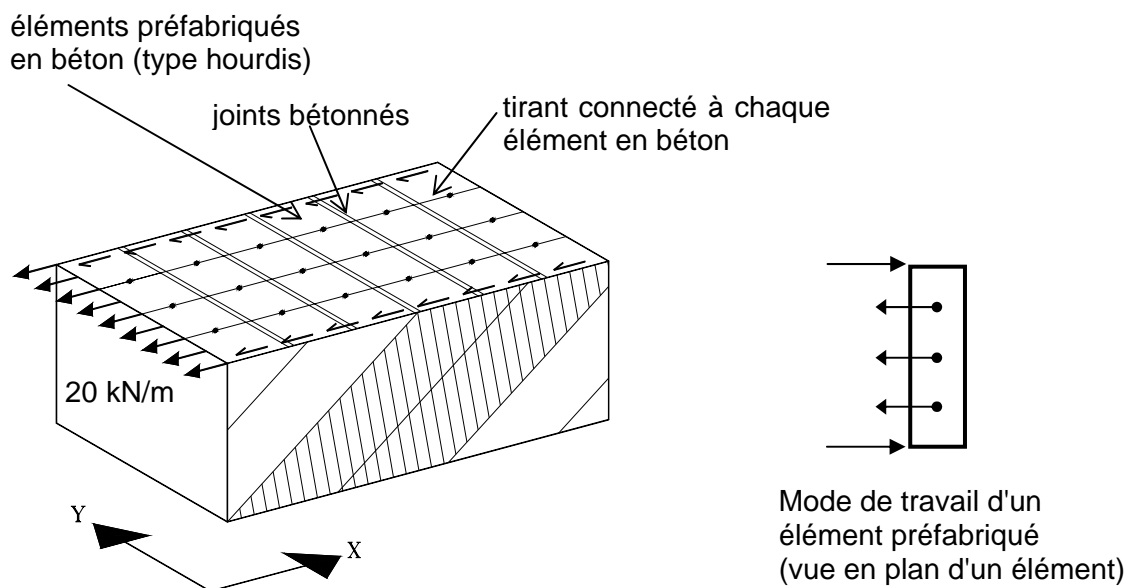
Plancher constitué d'éléments préfabriqués en béton. Reprise d'une action sismique de direction x
